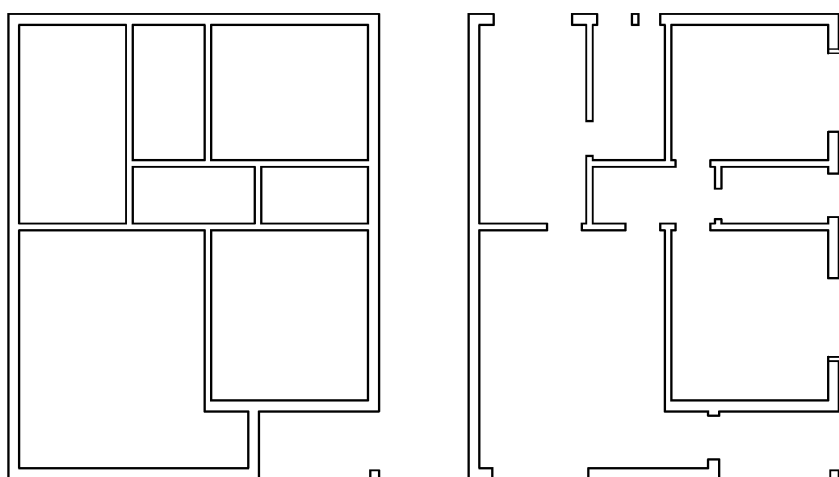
Etapas de representação da planta baixa: paredes e vãos. Fonte: autor
